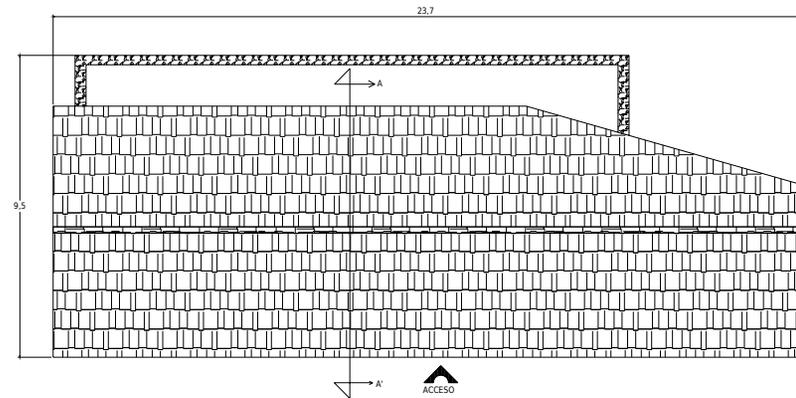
PLANTA DE CONJUNTO DE LA FICHA No. 1.
